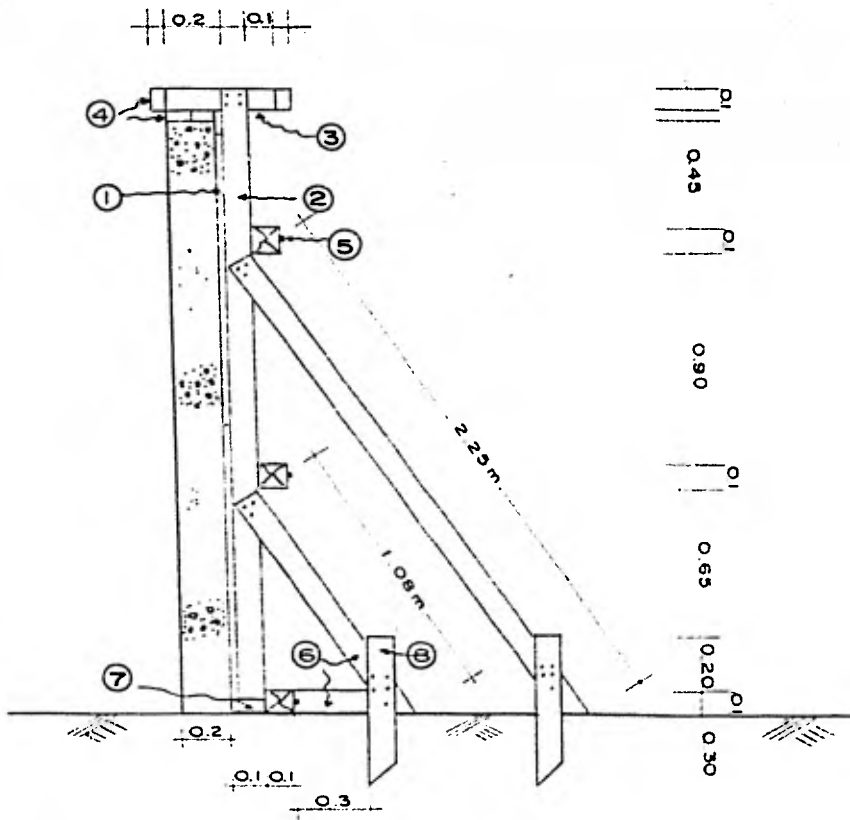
Cimbra en muro de concreto, para el método del concreto lanzado.
